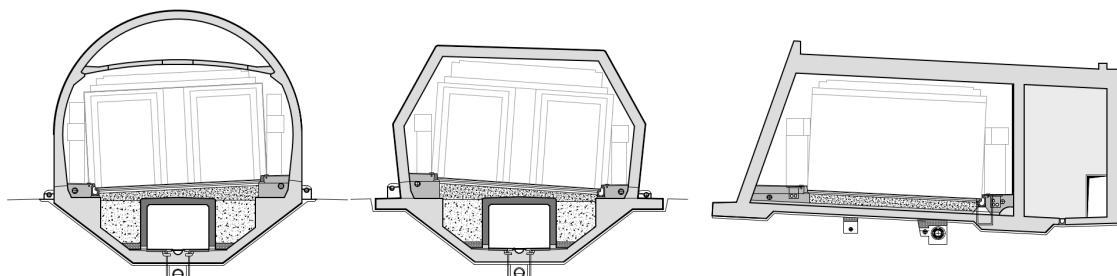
Sections transversales des tranchées couvertes du tunnel de Choindez et du tunnel de la RC6
